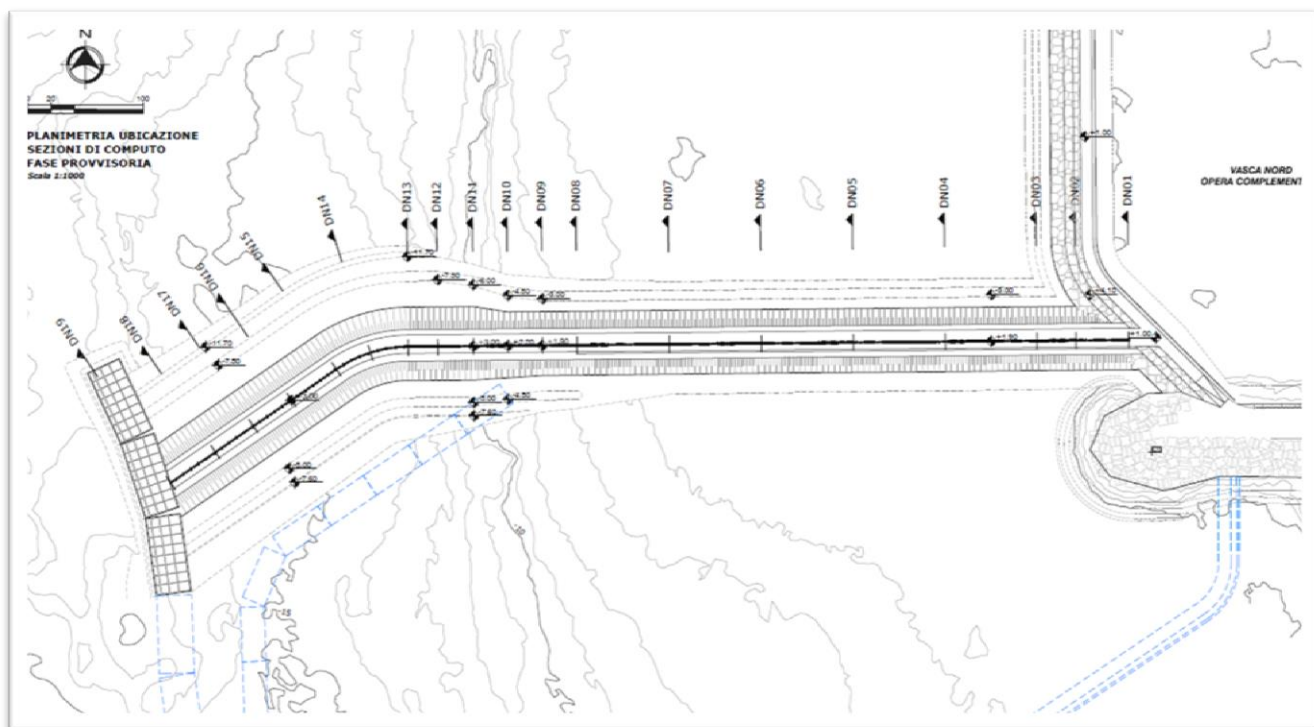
Planimetria della Diga a Gettata Nord come da Perizia di variante n.1 e n.2
